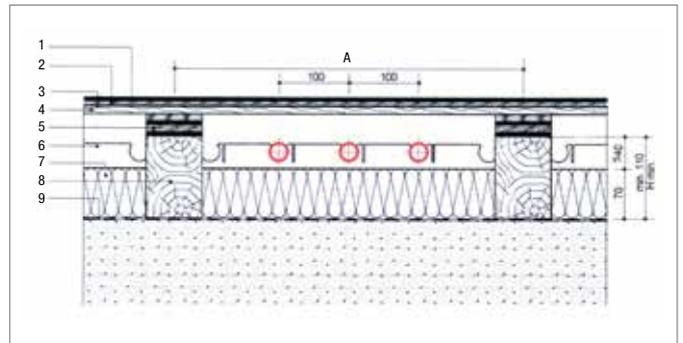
Struttura del riscaldamento a pavimento flettente
